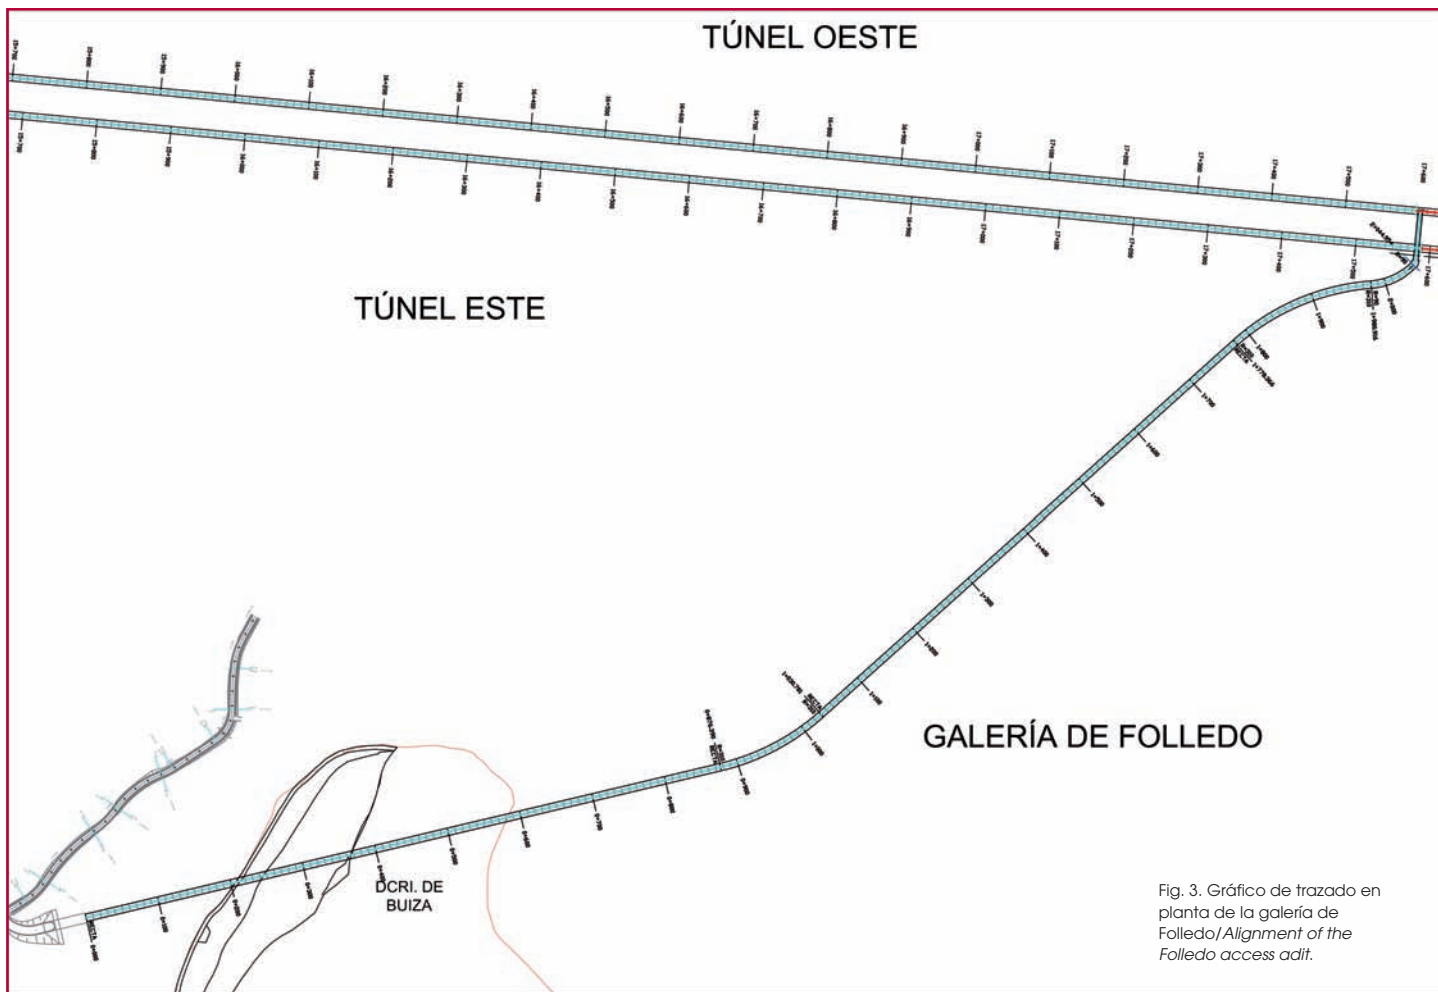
Gráfico de trazado en planta de la galería de Folledo/Alignment of the Folledo access adit.
